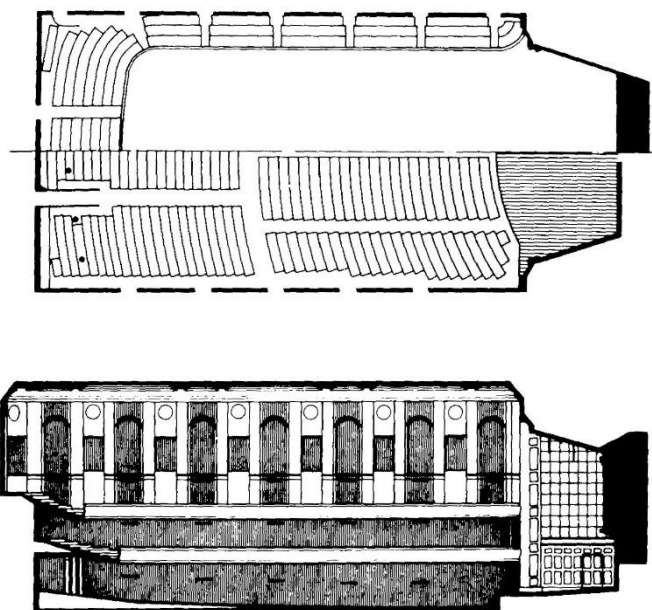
Planta y corte de una sala tipo “caja de zapatos” (Symphony Hall, Boston).
